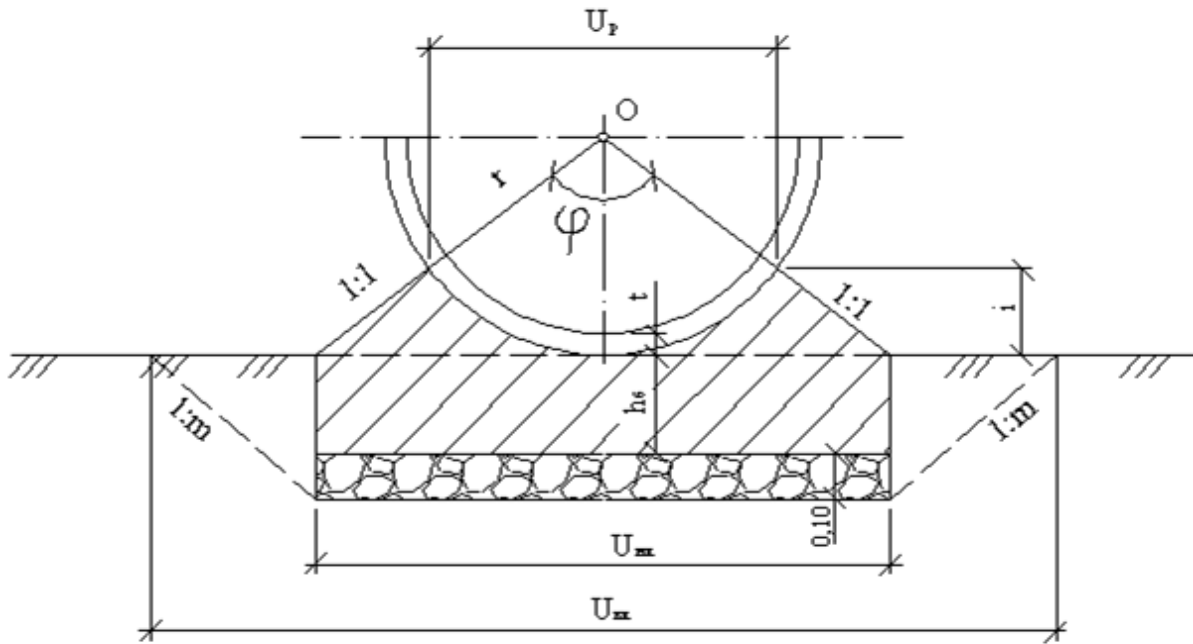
Поперечное сечение бетонного фундамента трубы
